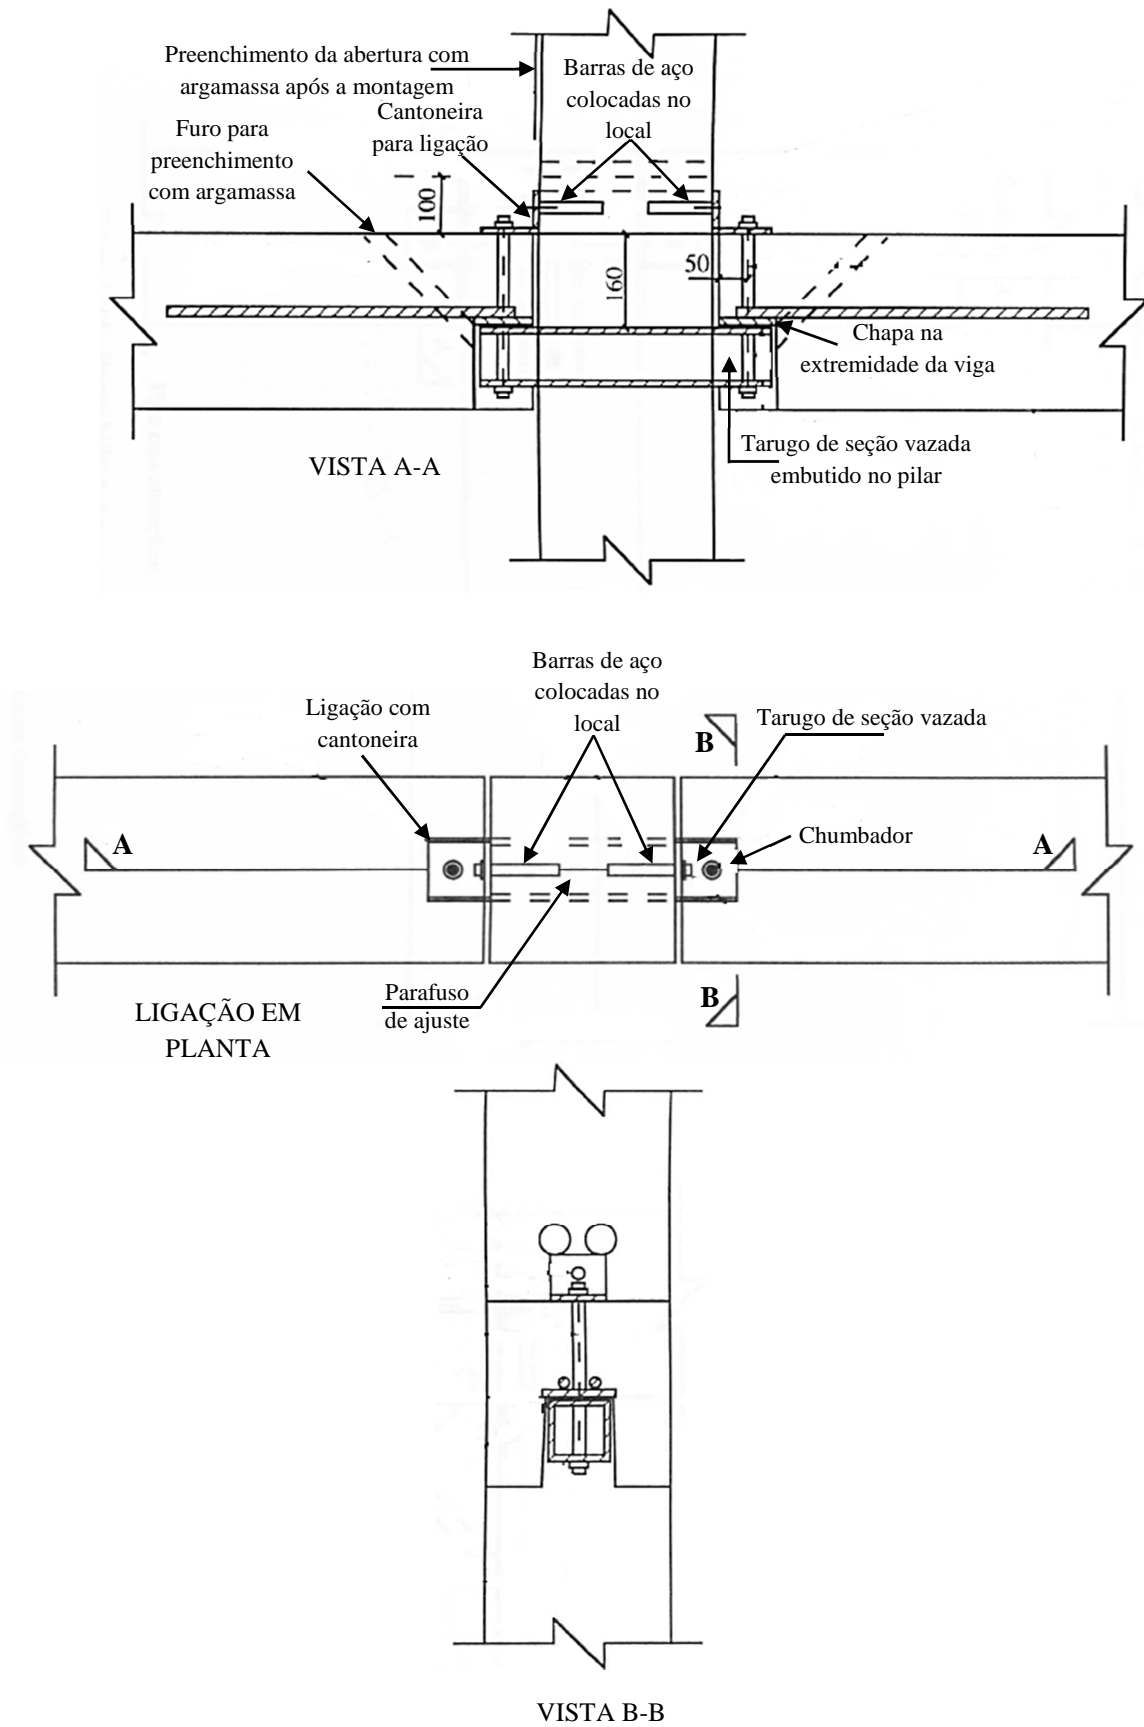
Ligação viga-pilar utilizando perfil de seção vazada e parafusado [GORGUN (1997)]
